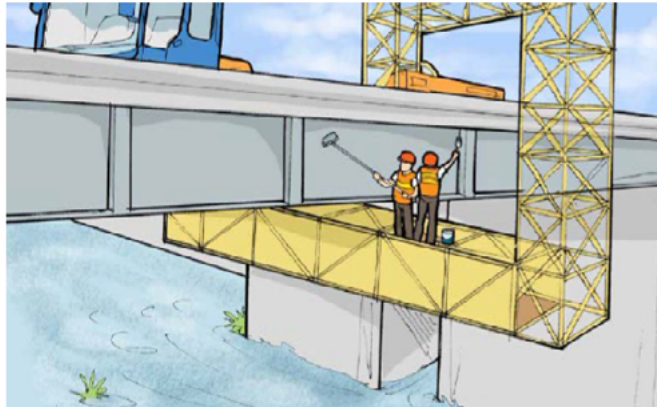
Pintado de vigas de acero con la ayuda de un vehículo de inspección.
